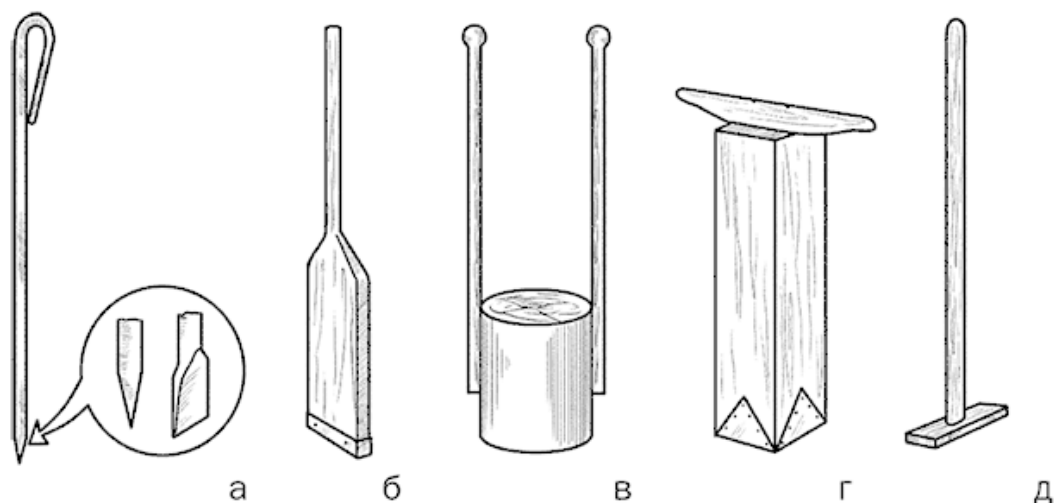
Приспособления для бетонных работ: а – шуп для штыкования; б – узкая трамбовка с металлическим уголком или п-образным профилем; в – круглая трамбовка; г – квадратная трамбовка; д – гладилка
